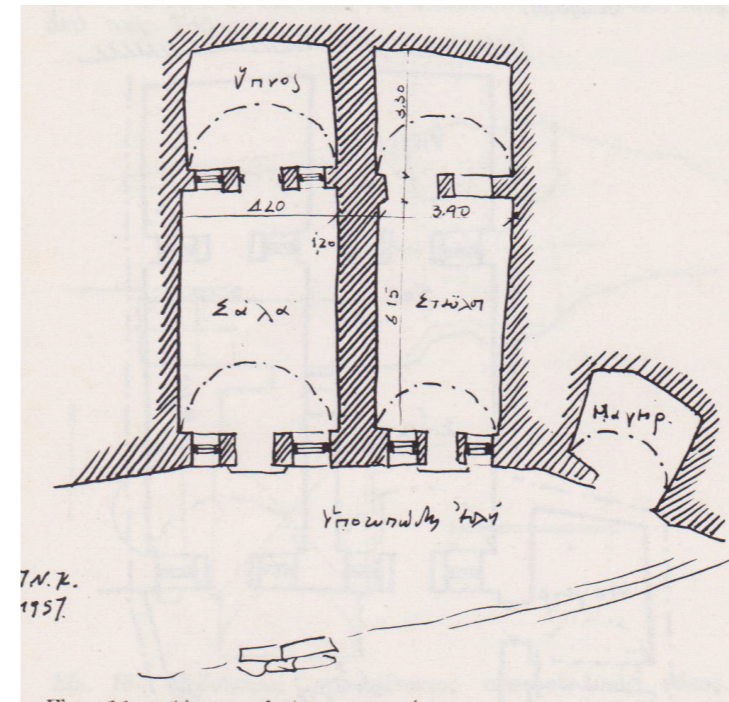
Esquema en planta de las construcciones de Oia⁸⁰.
